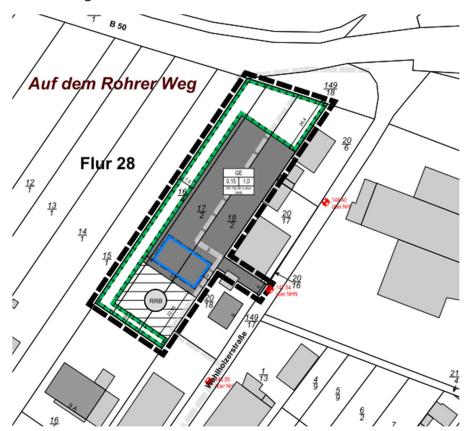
Ausschnitt Bebauungsplan, Quelle Büro Planung1
